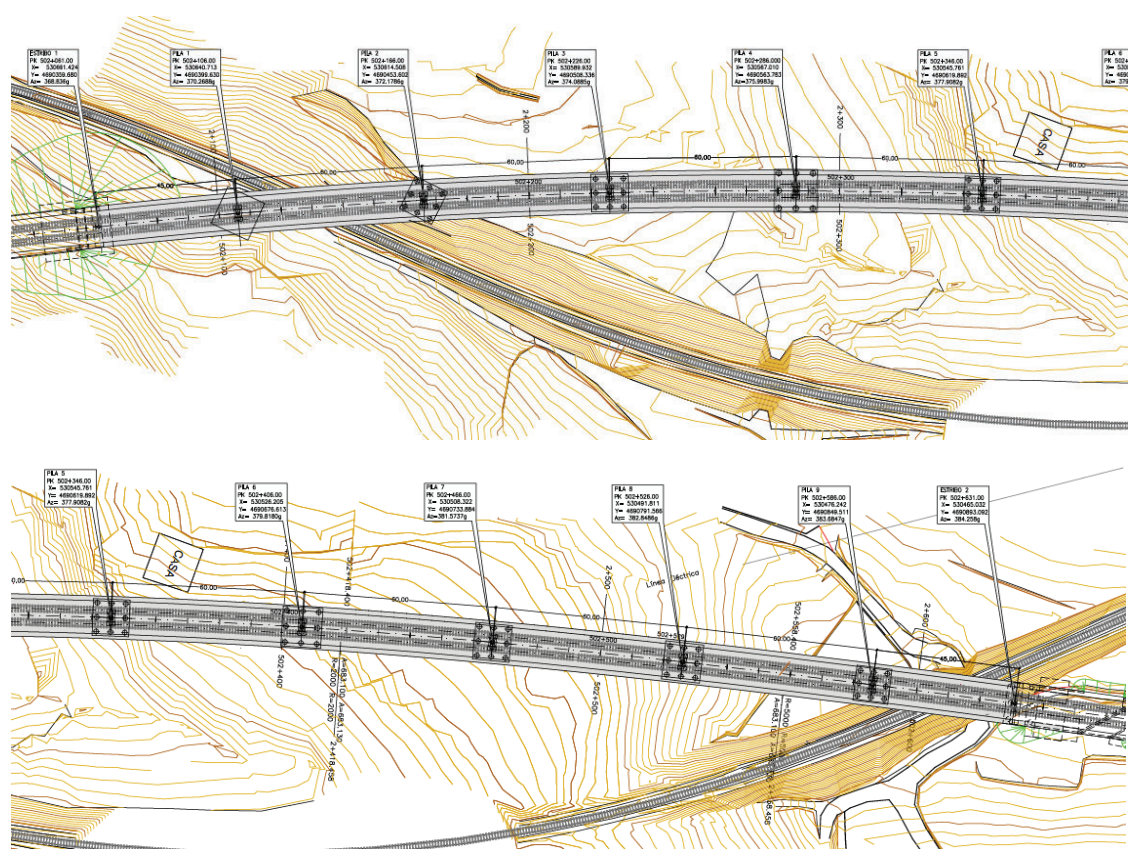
Planta de cimentación del viaducto de la LAV
